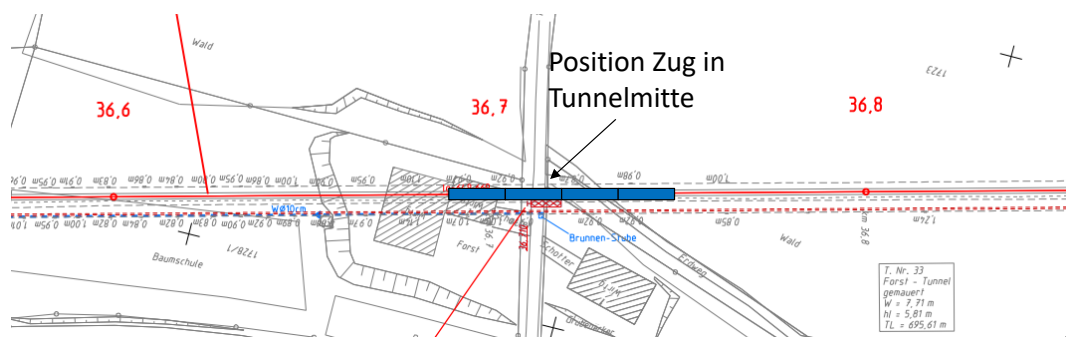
Positionierung des Zugs in Mitte des Tunnels Forst (Ausschnitt aus Lageplan 09)
